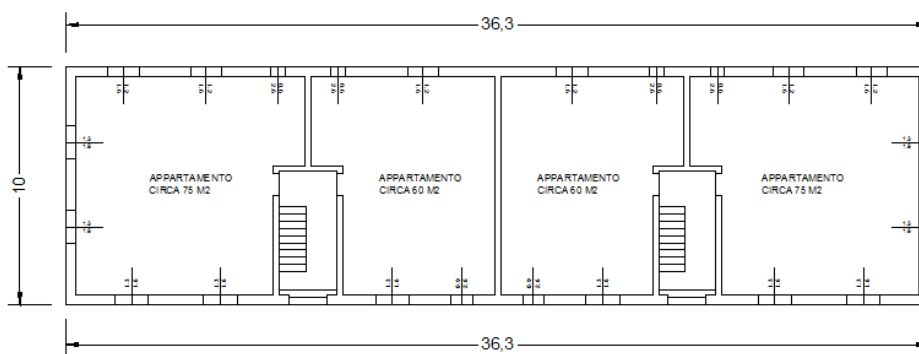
Planimetrie Edificio Tipo 1.1
